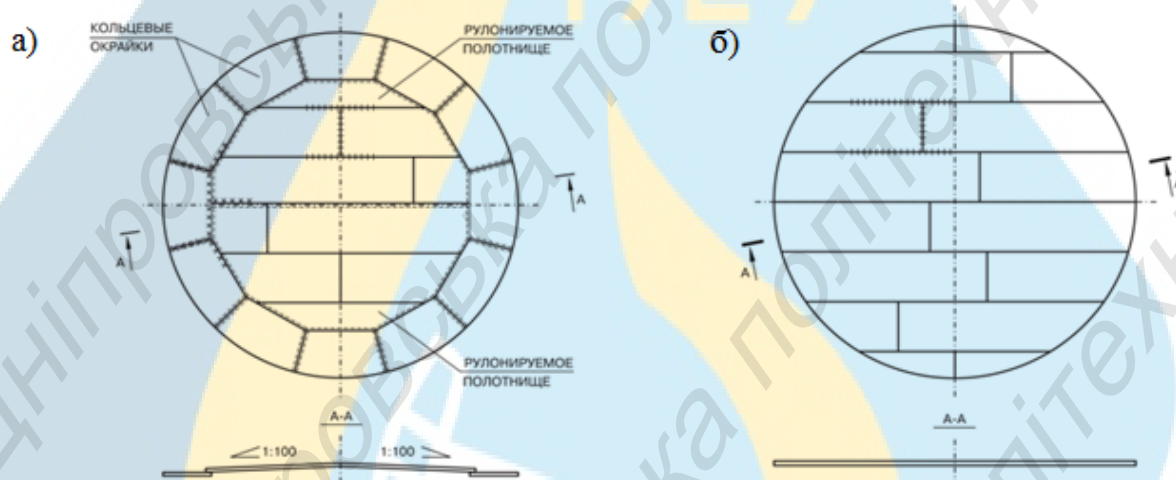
Конструктивні рішення днищ резервуарів: а) – конічне з окрайками; б) – пласке
